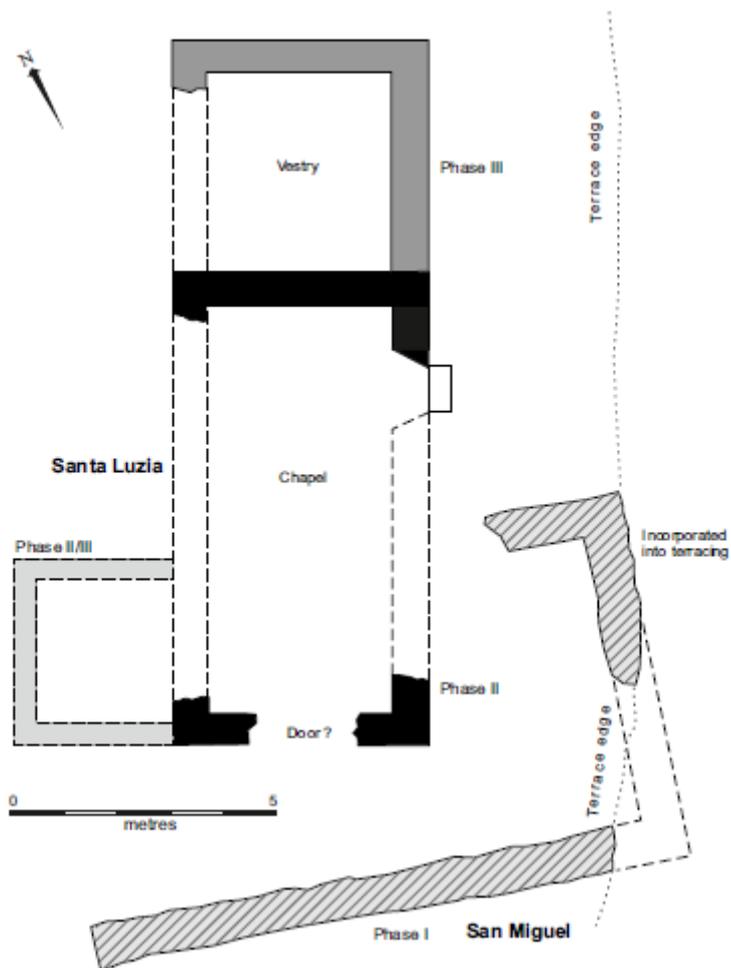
Planta da capela de Santa Luzia, e restos do muro da Capela de São Miguel (in EVANS *et al*, 2014, p.13).
